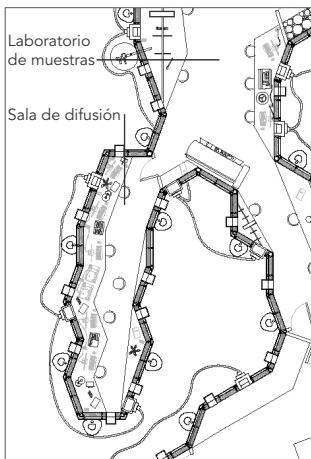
Planimetría espacios de laboratorio búnker. 1:250
